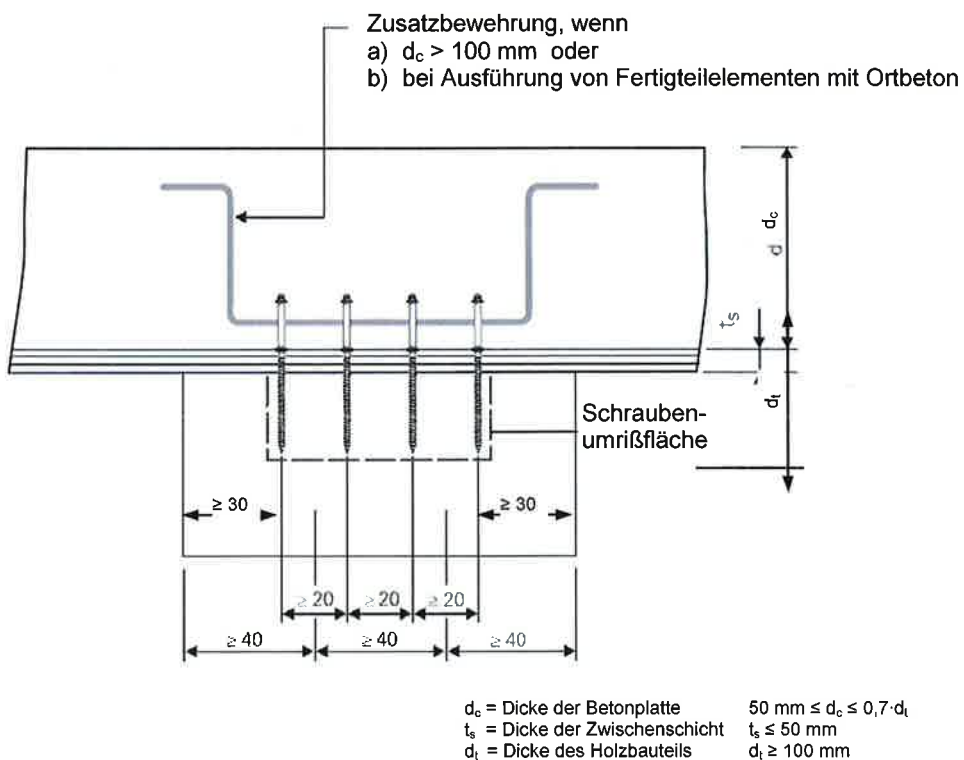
Querschnitt einer Holz-Beton-Verbundkonstruktion mit SFS VB Schrauben
